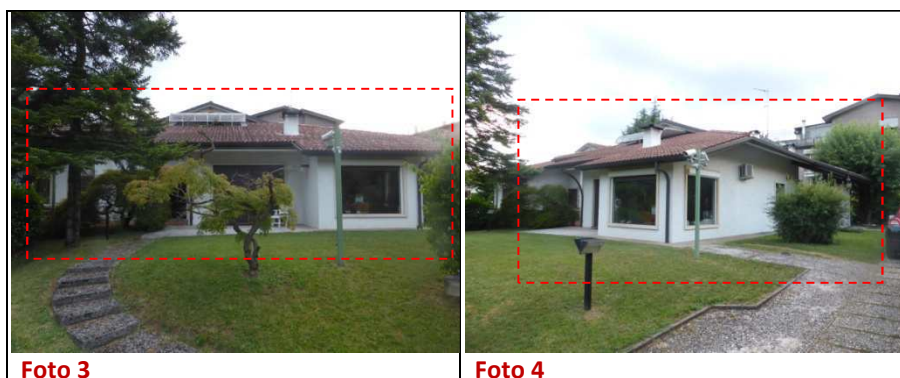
Vista prospettica del fabbricato – lato nord-est dell'abitazione oggetto di esecuzione	Foto 4: Vista prospettica del fabbricato – lato nord-ovest dell'abitazione oggetto di esecuzione
